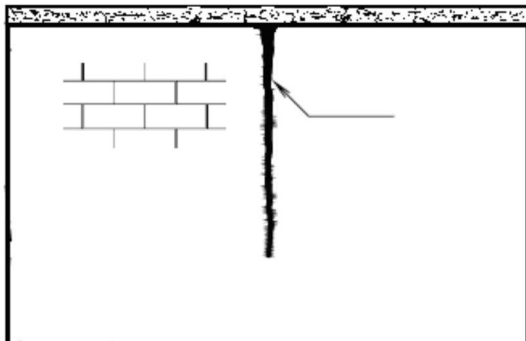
Fissura em paredes longas e com aberturas
